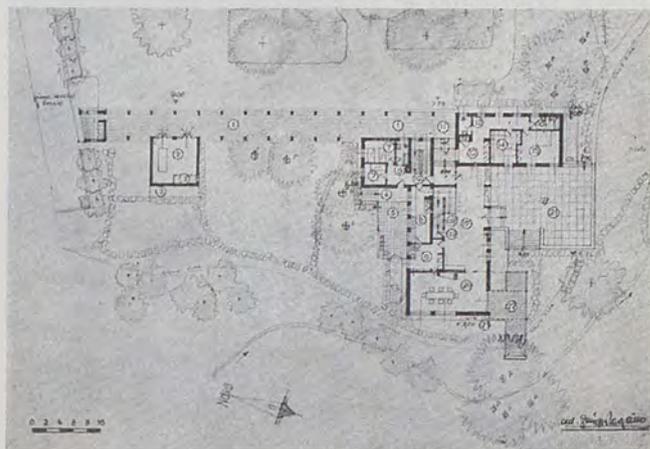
b - Villa Caraccio: pianta del piano terreno.
